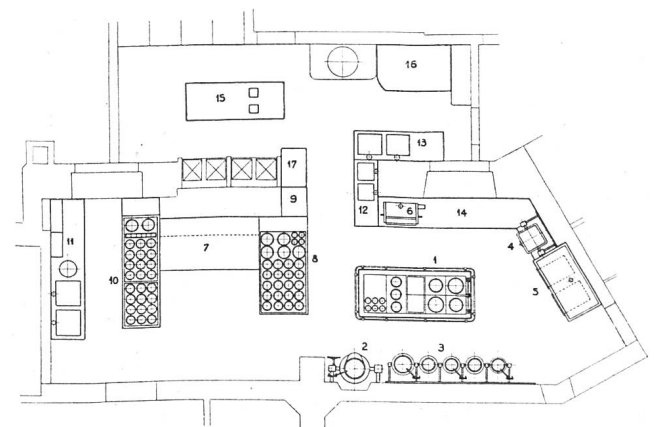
Grundriss der elektr. Küche im Vegetarierheim.
